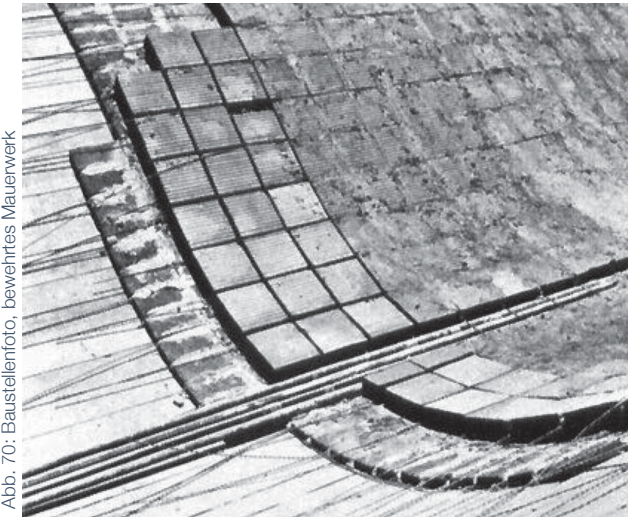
Baustellensfoto, bewehrtes Mauerwerk
